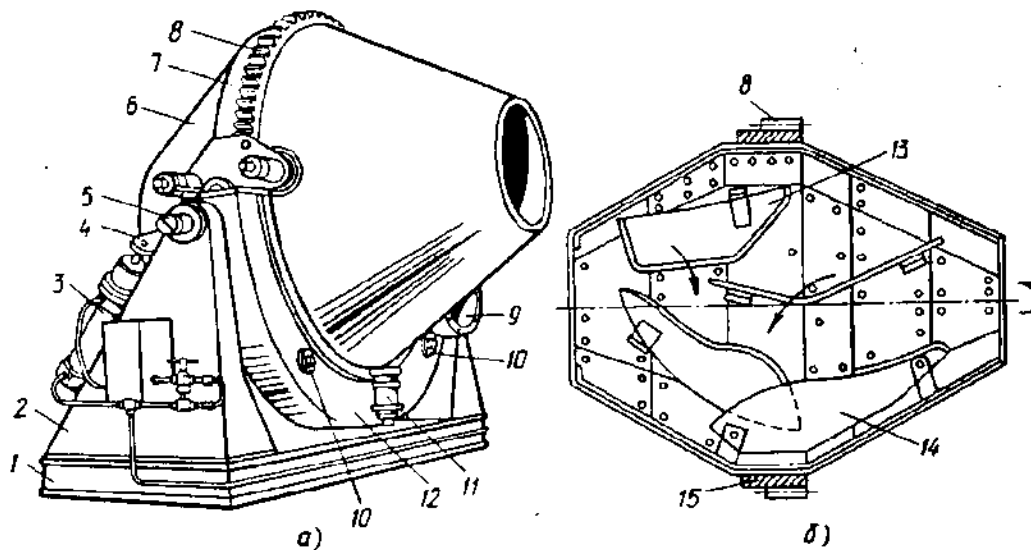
Бетоносмеситель с двухконусным барабаном: *а* - общий вид; *б* - схема устройства смесительного барабана; 1 - станина; 2 - стойка; 3 - пневмоцилиндр; 4 - кронштейн; 5 - шип траверсы; 6 - барабан; 7, 15 - обод; 8 - зубчатый венец; 9 - электродвигатель; 10 - опорные ролики; 11 - упорный ролик; 12 - траверсы; 13, 14 - лопасти
